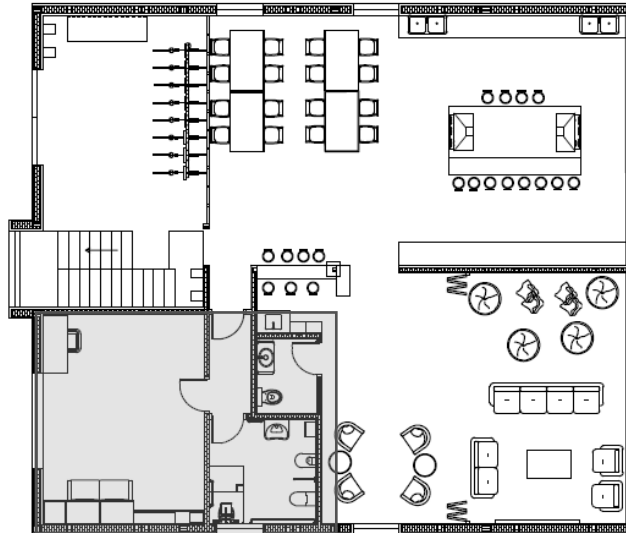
Proposta 2 de estudo do piso 0 em autocad
